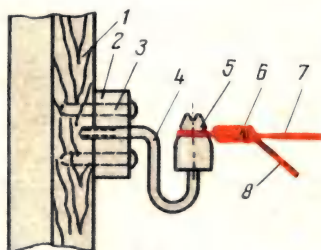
Крепление крюка на стене каркасно-защипного здания:
